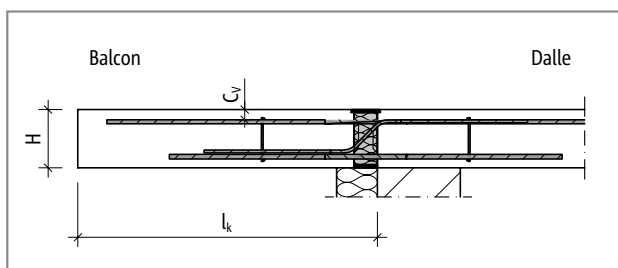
Schöck Isokorb® T Type K-M13 : Système statique
